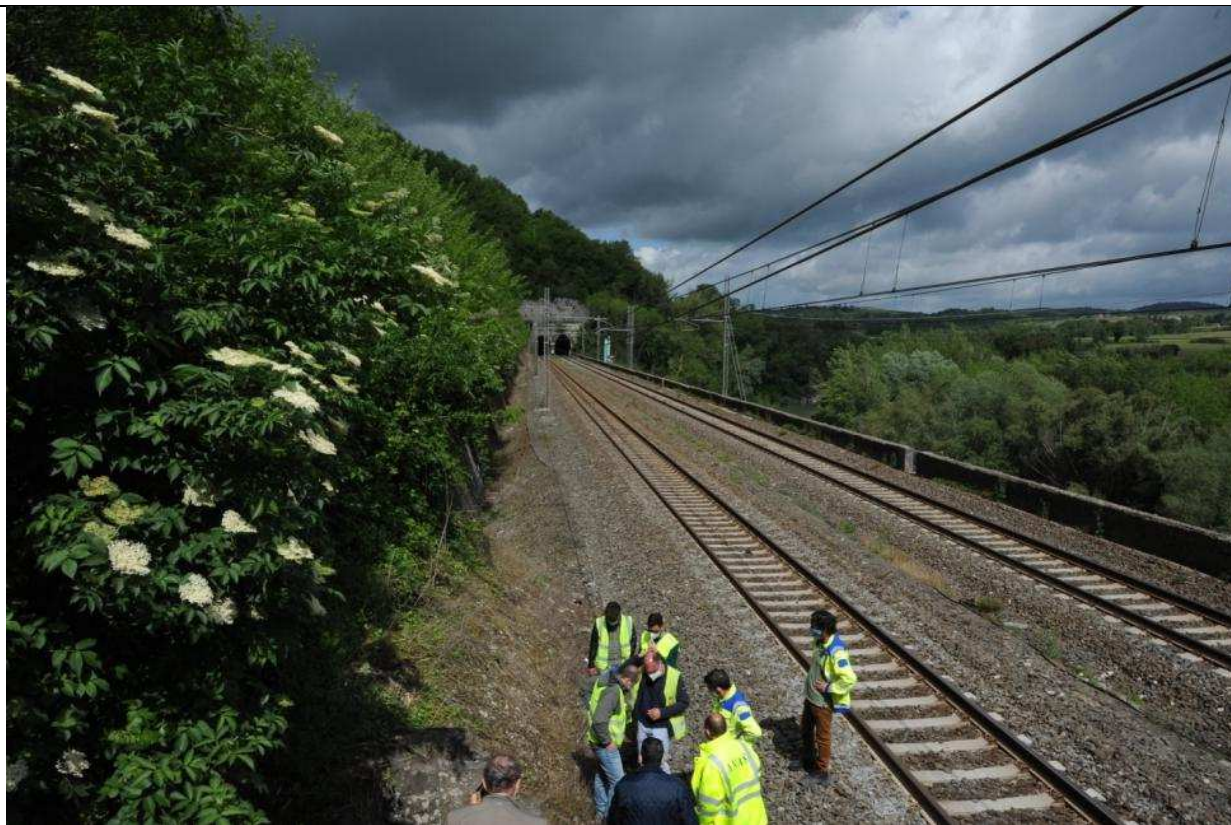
Vista verso ovest dal tracciato ferroviario. Sullo sfondo la galleria del nodo 1
